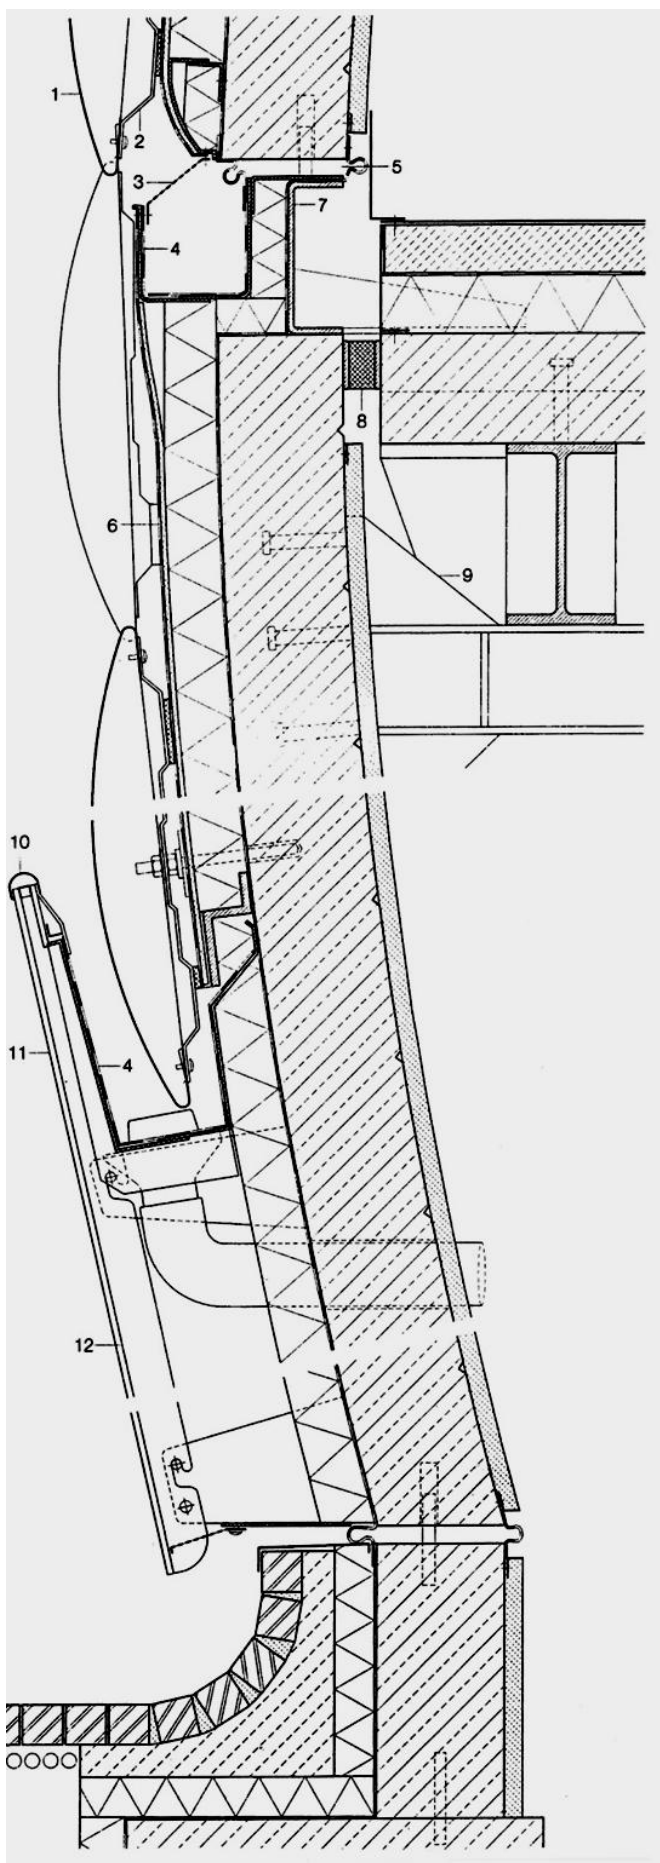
Фрагмент разреза. Примыкание междуэтажного перекрытия. Нижняя зона фасада:
